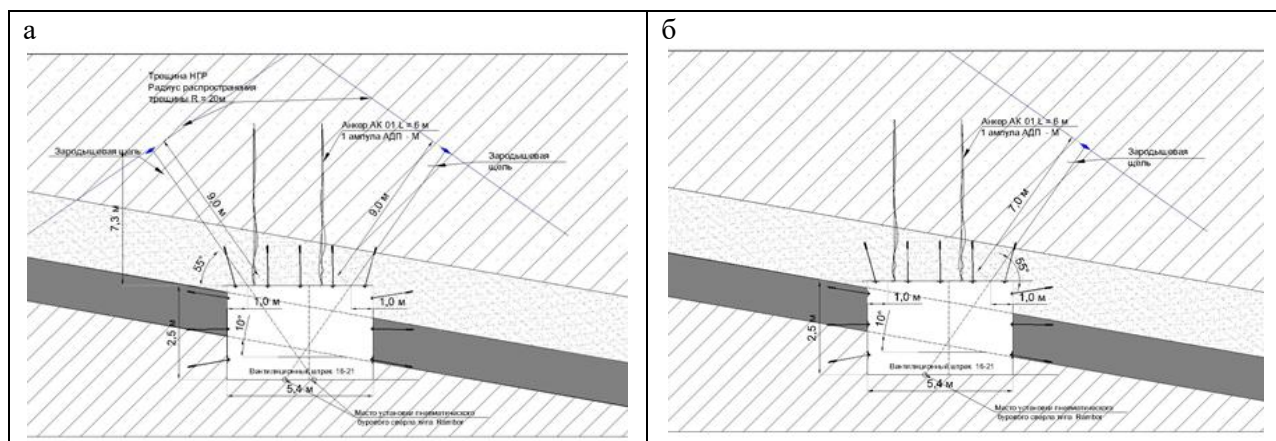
Вертикальная схема заложения скважин гидроразрыва пород кровли пласта 16 из вентиляционного штрека 16-21: а – вид А-А; б – вид Б-Б
